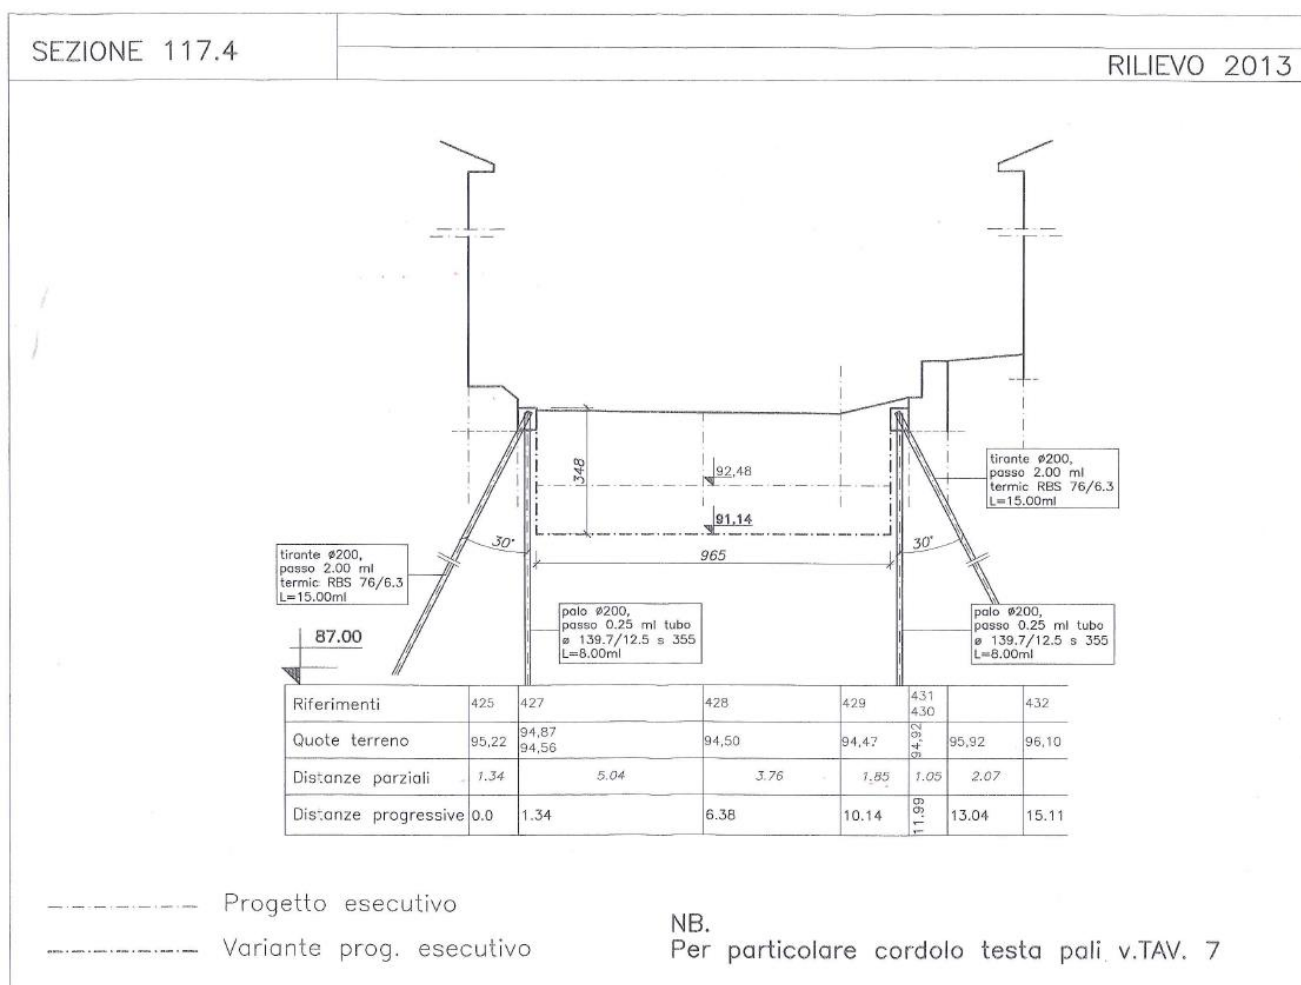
Sezione tipologiche di progetto (Berlinesi) – Estratto Pratica Sismica N. 292/2010 – variante 2014
